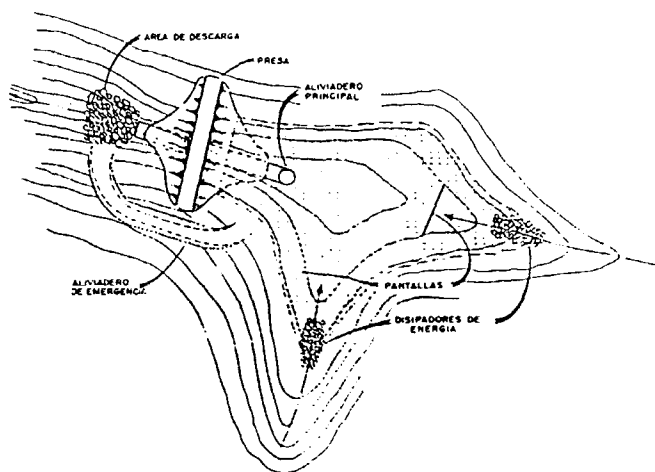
Esquema en planta de una balsa de decantación del tipo presa.
